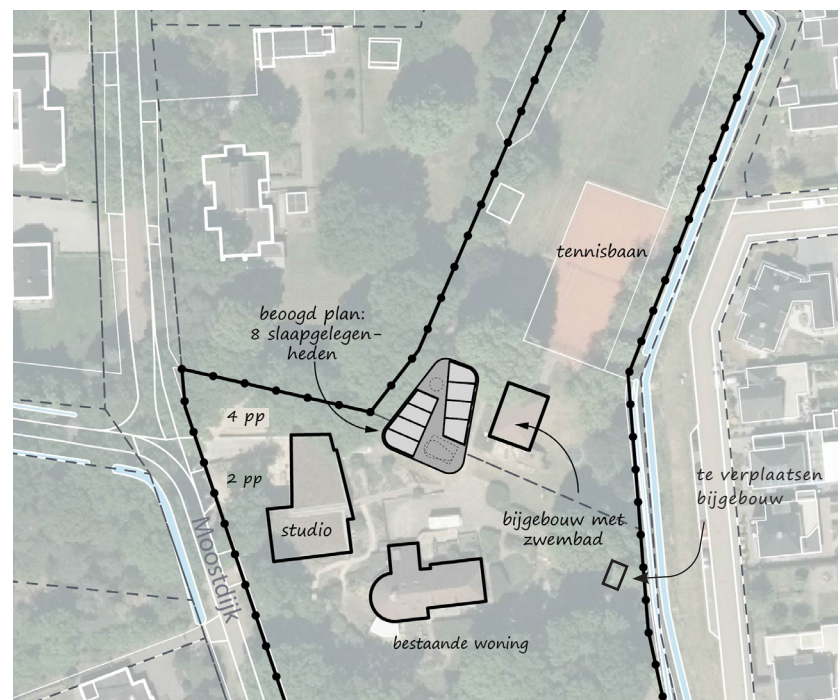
Luchtfoto met plangebied, bestaande situatie
